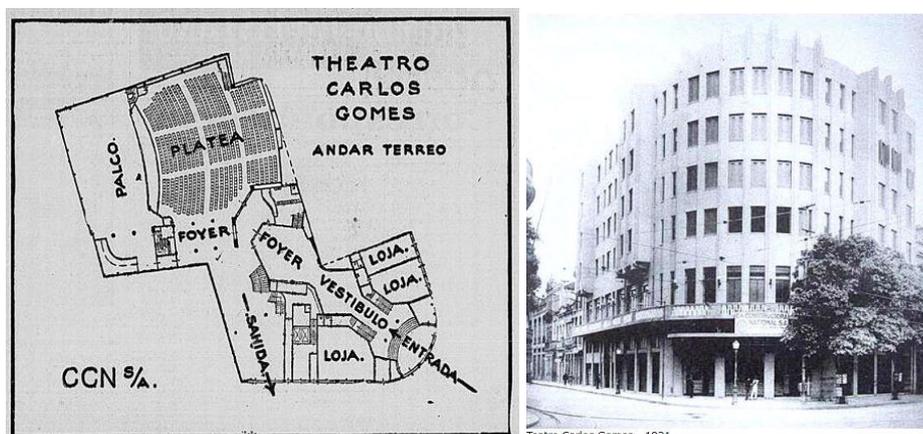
Planta Térreo Teatro Carlos Gomes e Fachada em 1932. (F. CORREIO DA MANHÃ - 1932 Edição 11444 (1) p21 (05/06/2020))
